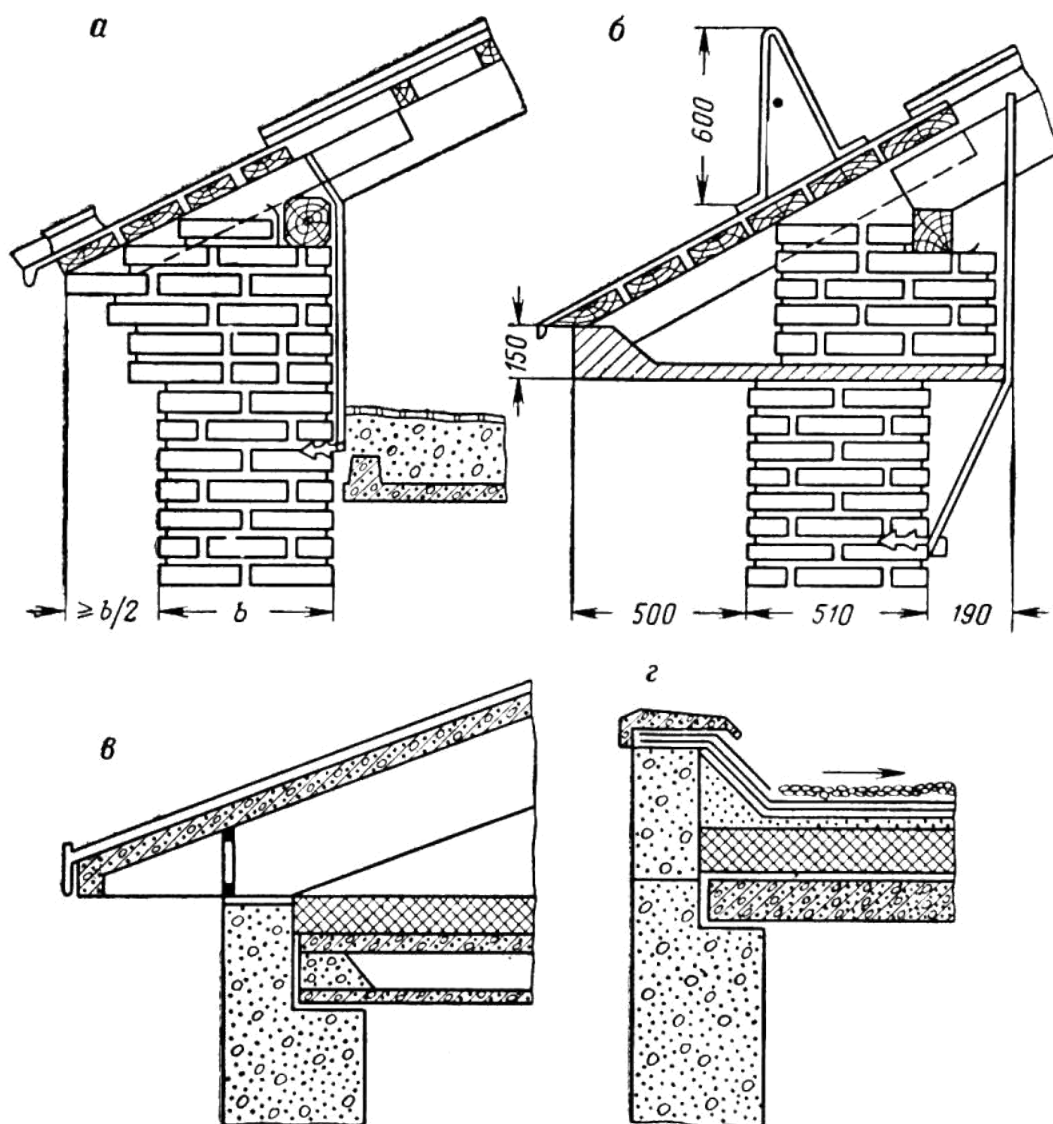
Конструкции венчающих карнизов: а — карниз, образуемый напуском кирпича; б — карниз из сборных железобетонных элементов; в — карниз, образуемый свешивающимися со стены железобетонными элементами покрытий и крыш; г — парапет при плоском покрытии с внутренним водостоком
